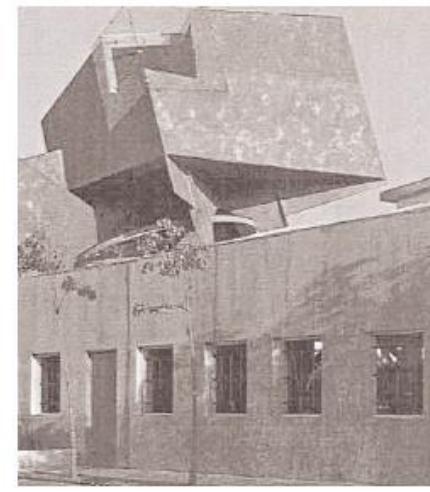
Ouvrages sur le toit d'immeubles : configurations à éviter.
